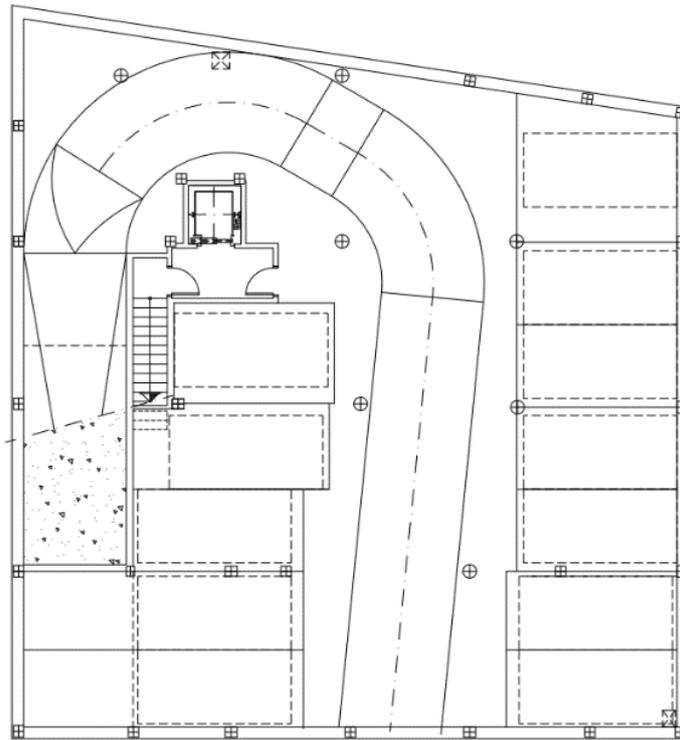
Planta Sótano Edificio Pla de l'Arc, 2010.
